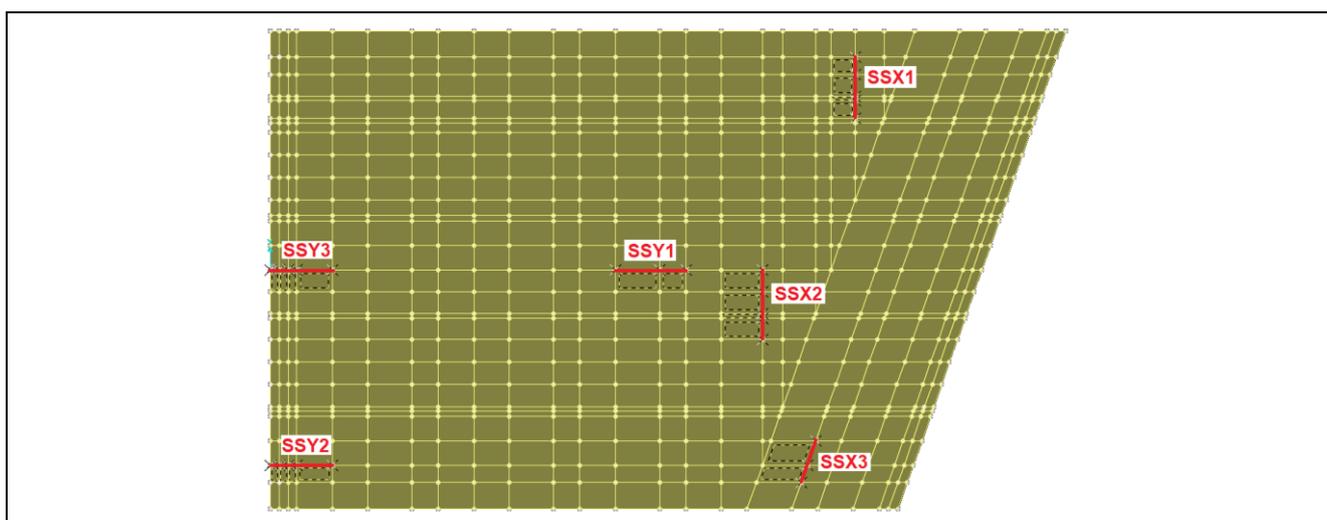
Sezioni di verifica della spalla - muro posteriore e soletta superiore
